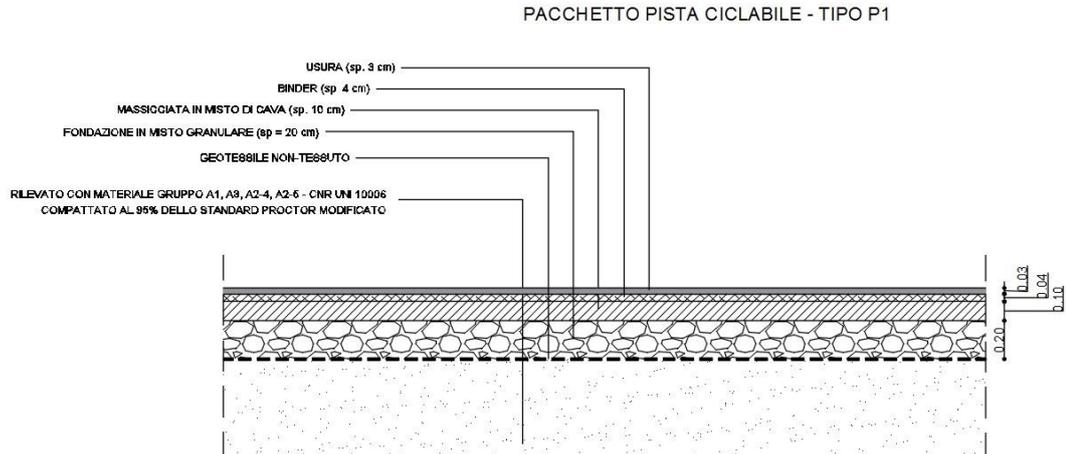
Pacchetto Pavimentazione Stradale "Tipo 1"
